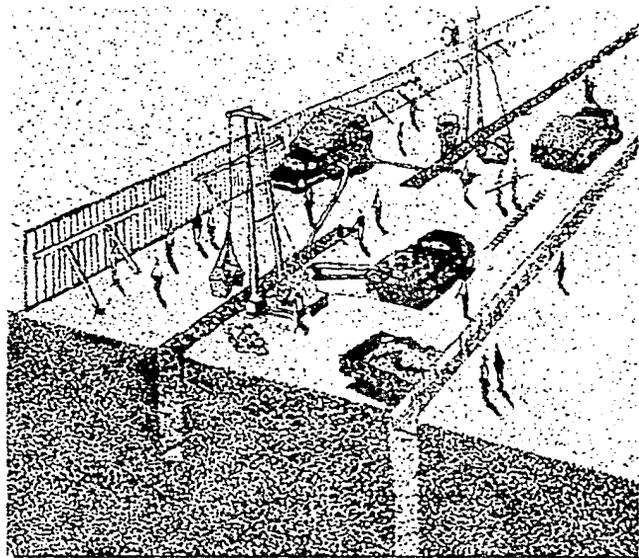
Procedimiento constructivo de muros colados en sitio.
